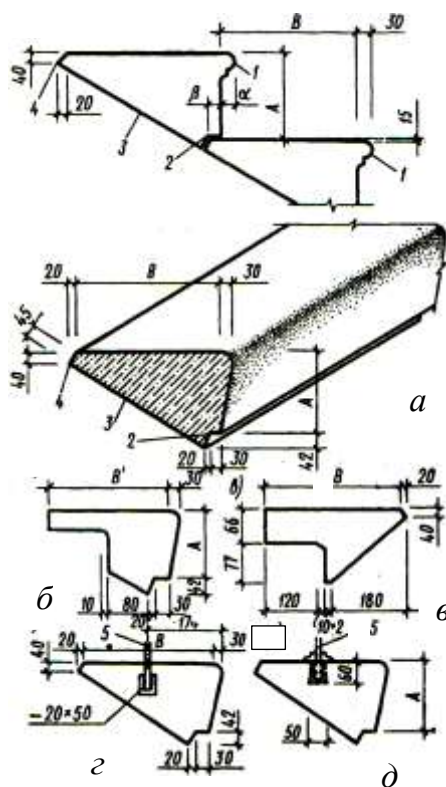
Збірні залізобетонні сходинок з дрібнорозмірних елементів: а – рядові; б, в – верхня і нижня фризиви; г, д – кріплення стояка огороження до бокової та верхньої площин сходинок; 1 – валик; 2 – хвіст; 3 – постіль; 4 – замок; 5 – стійка огороження
